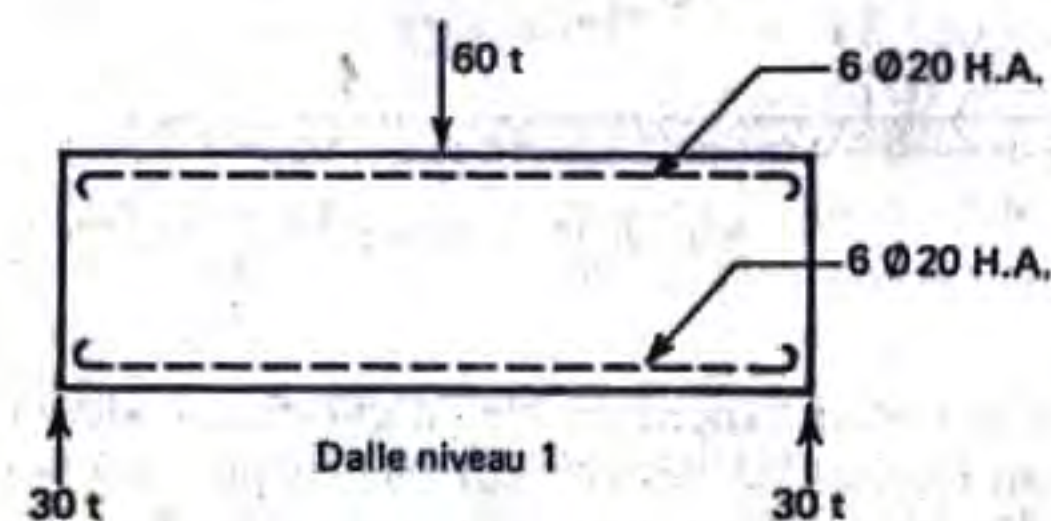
Poteaux au rez-de-chaussée. Cas particulier et exemple numérique.
